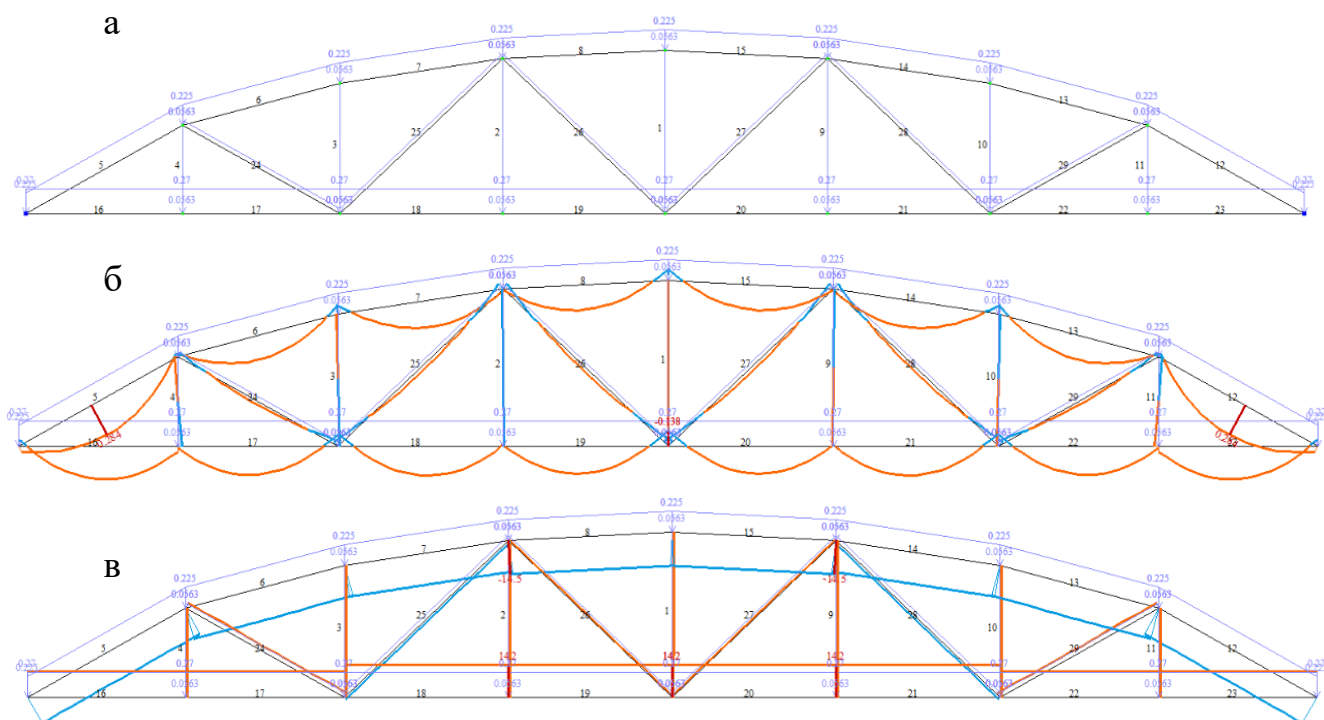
а) Розрахункова схема навантаження від власної ваги ферми Ф-2;
